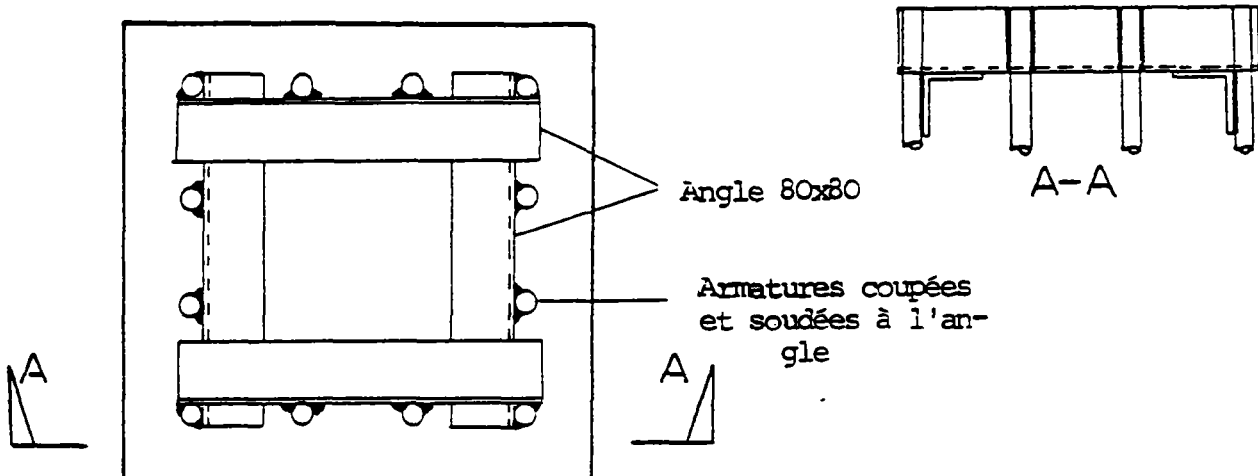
ARRET des ARMATURES LONGITUDINALES
